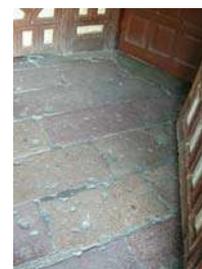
Detalle de baldosas de cantería del acceso.
